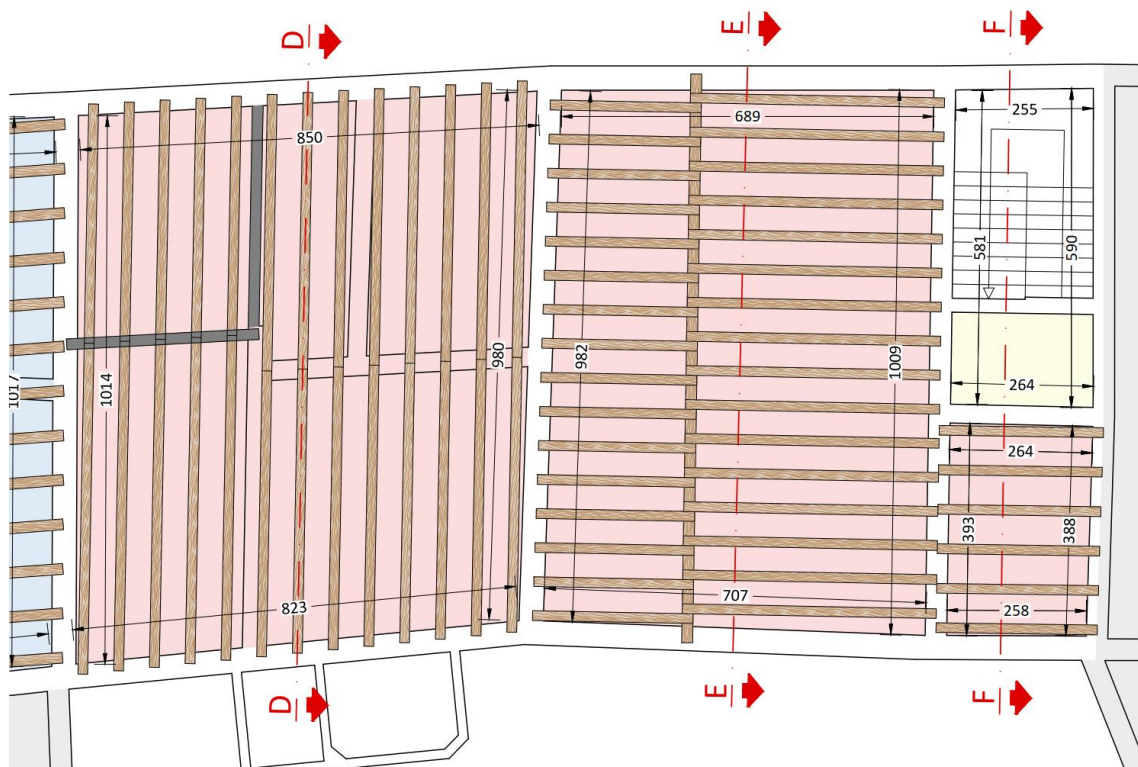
Pianta solaio piano terra dei blocchi D,E,F
